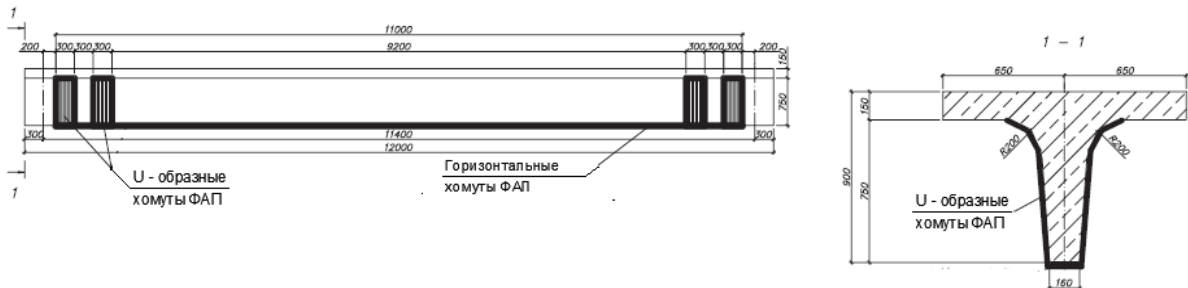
Усиление железобетонных балок фиброармированным пластиком
